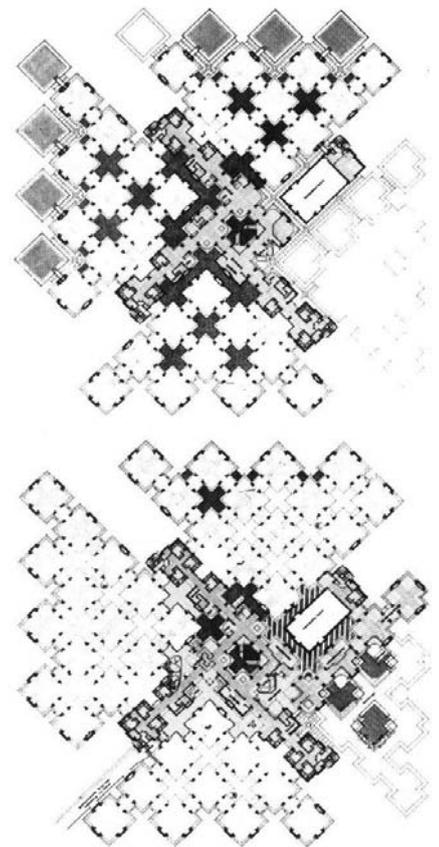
Aldo van Eyck, Orfanato de Amsterdam, planta, 1959.
